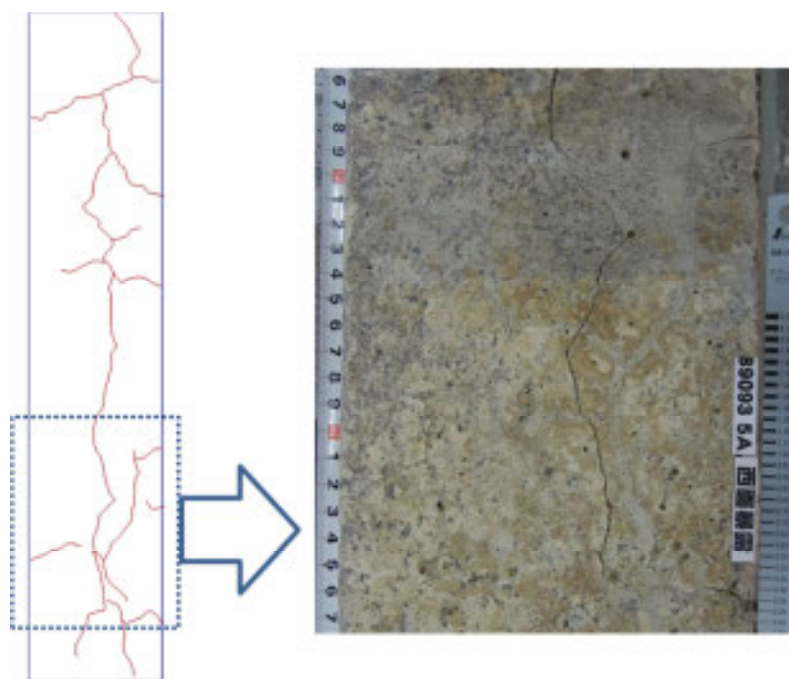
マップ状ひび割れ(c3)の例
